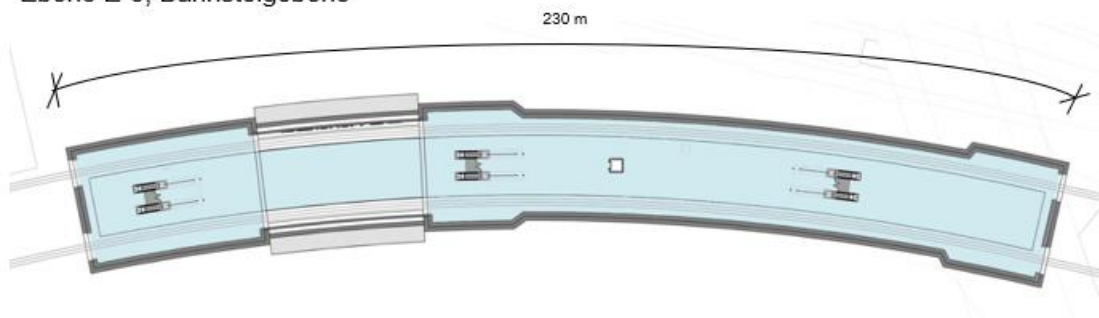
Hp Dammtor Var. III – Grundrisse
